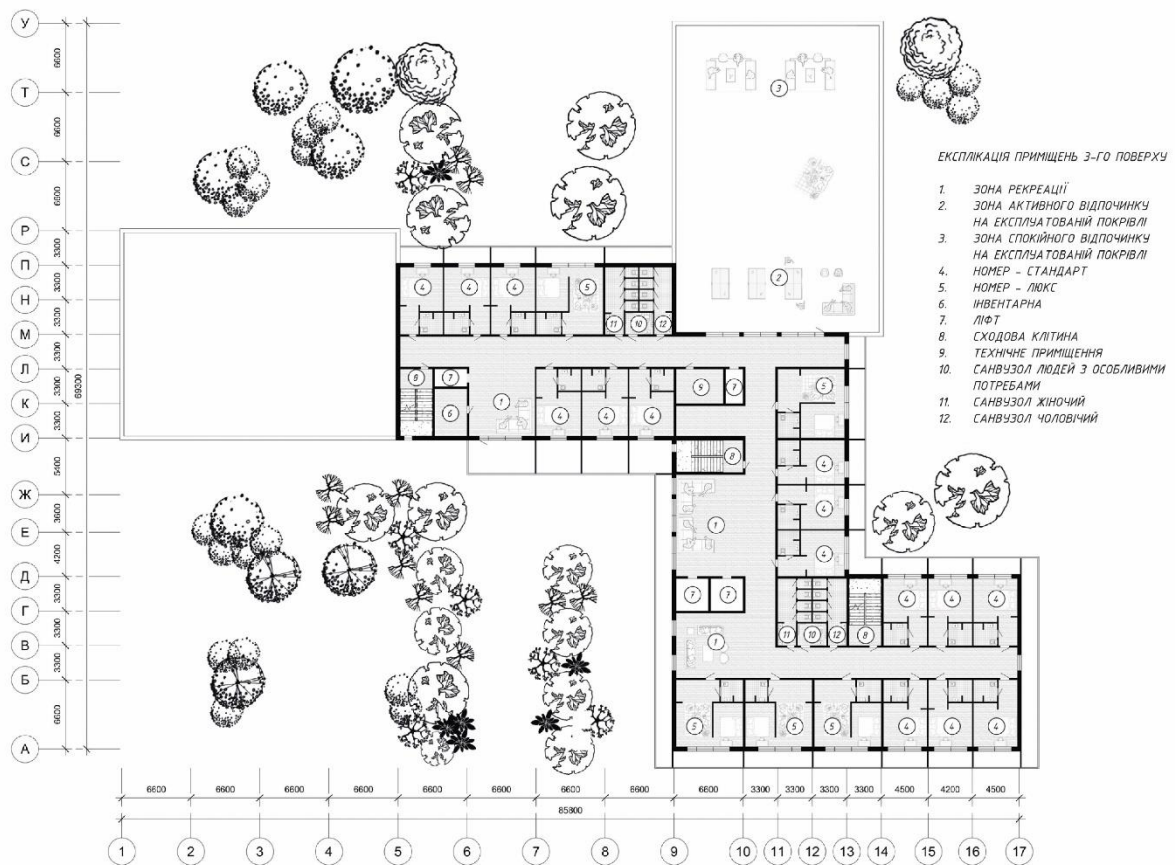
План 3-го поверху на відмітці 6.600 м
